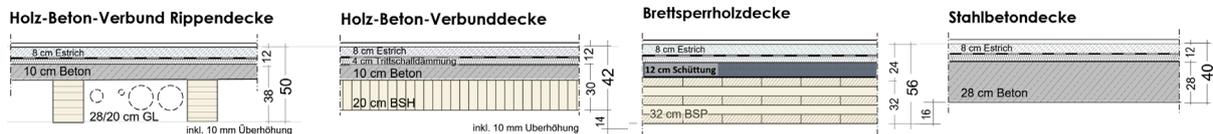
Abschätzung der Abmessungen für 8,10 m weit spannende Holz-, HBV- und Betondecken
